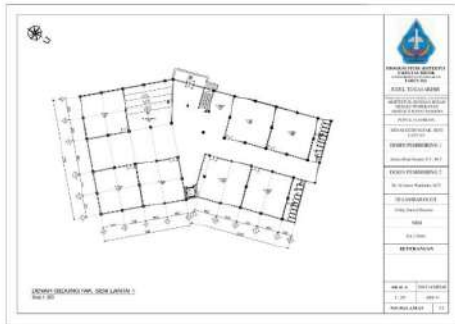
Denah Gedung Penunjang Lantai 1
